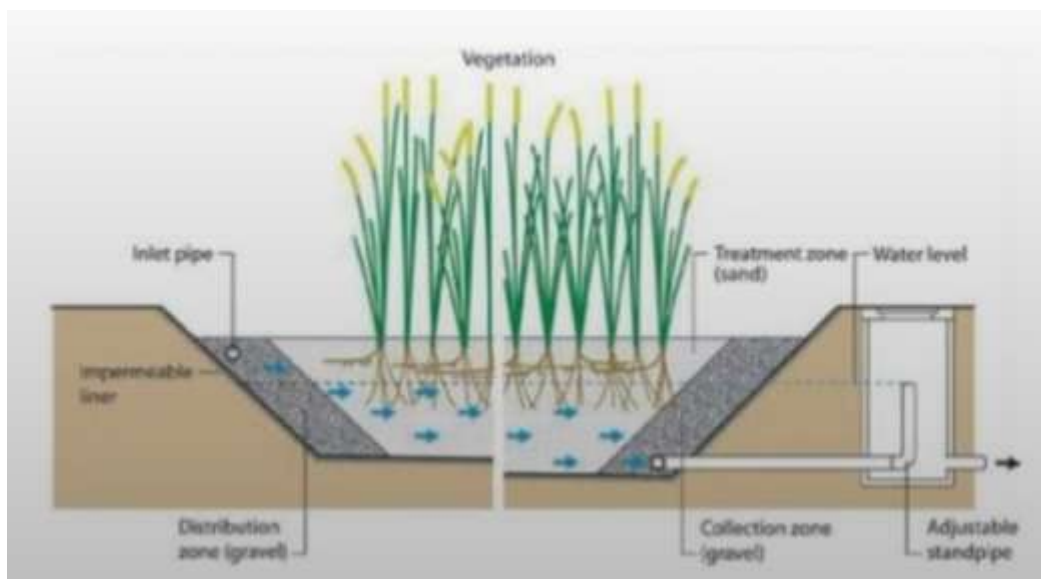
Esquema de Sistema Alagado Construído Escoamento Superficial; Sistema Alagado Construído de Escoamento Horizontal; Sistema Alagado Construído Vertical; Escoamento Superficial
